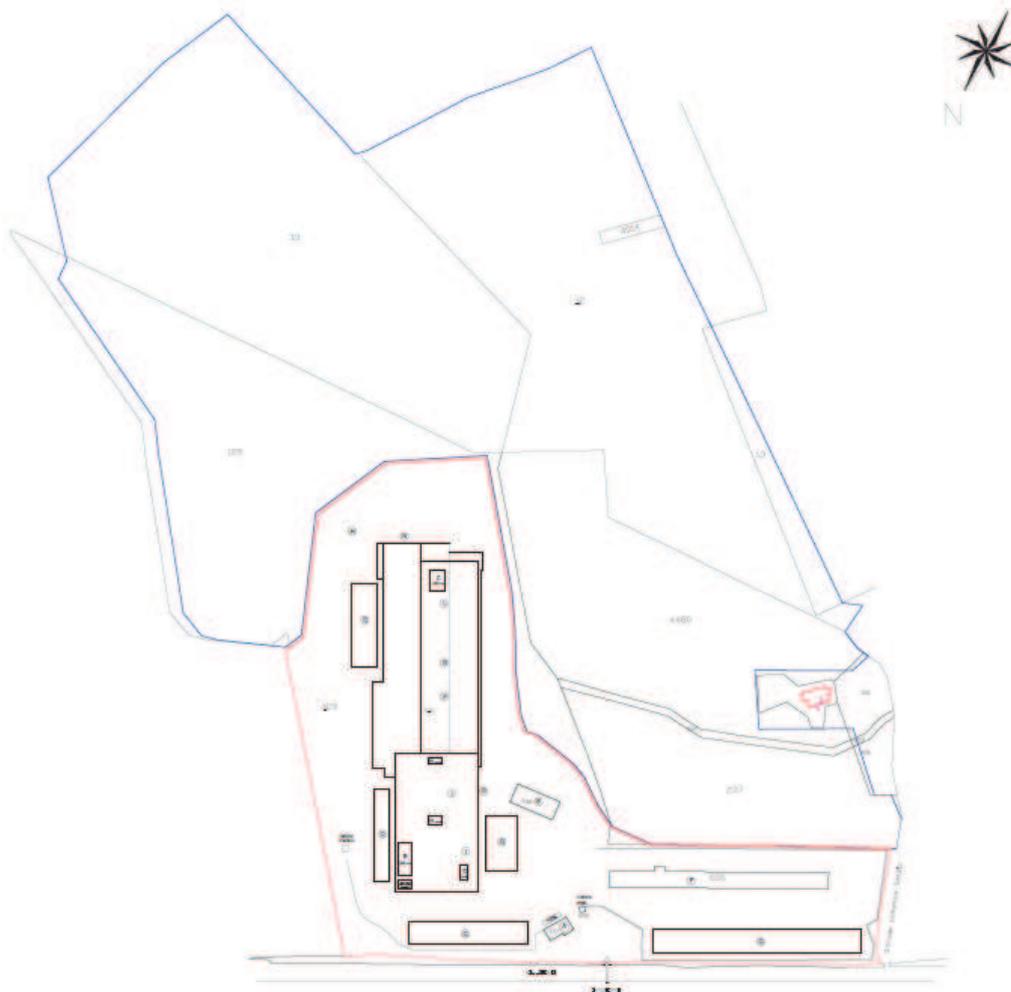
Planimetria generale sito. Perimetrata in rosso area produzione laterizi e recupero rifiuti non pericolosi - perimetrata in blu area di cava
